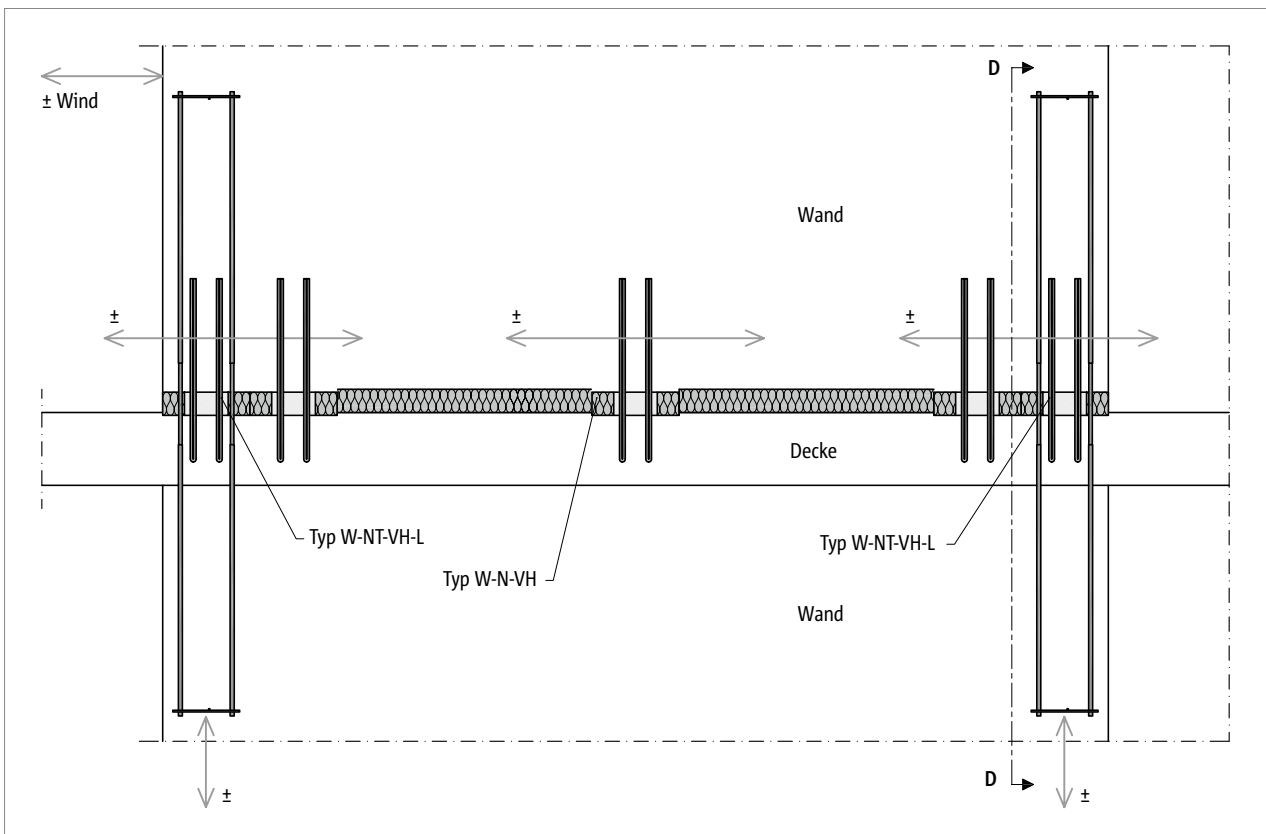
Schöck Scconnex® Typ W: Kombinierte Produktvarianten für den Anschluss einer horizontal belasteten, stabilisierenden Wand
